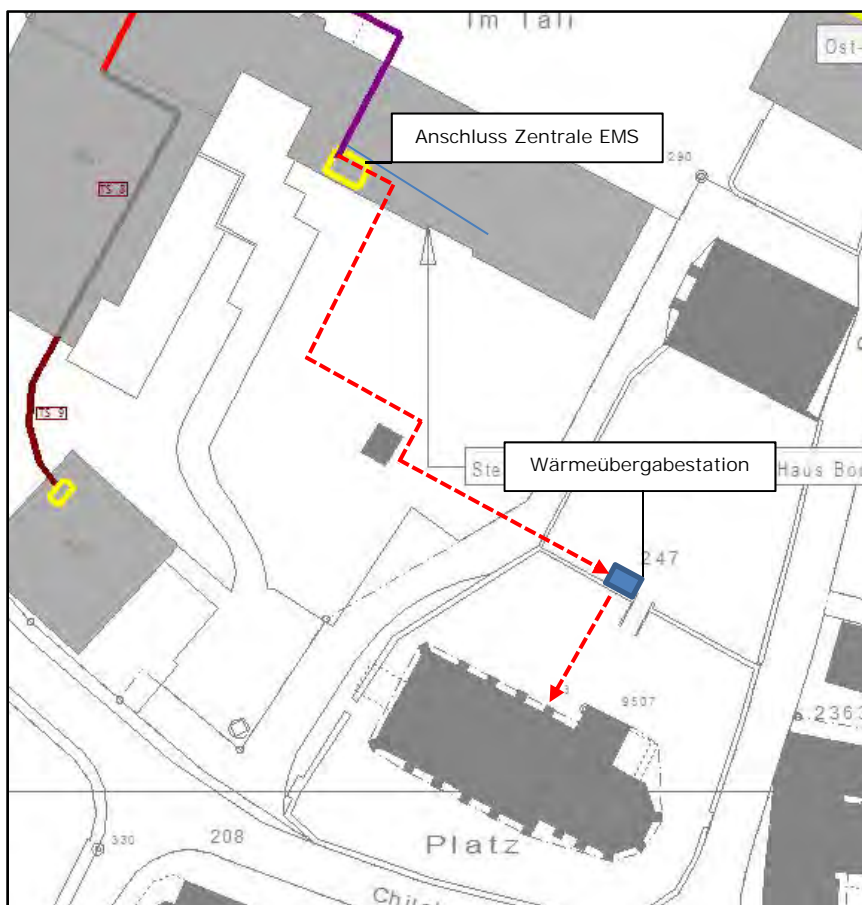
Anschluss Nahwärmeverbund EMS (Leitungsführung noch im Detail zu bestimmen)
